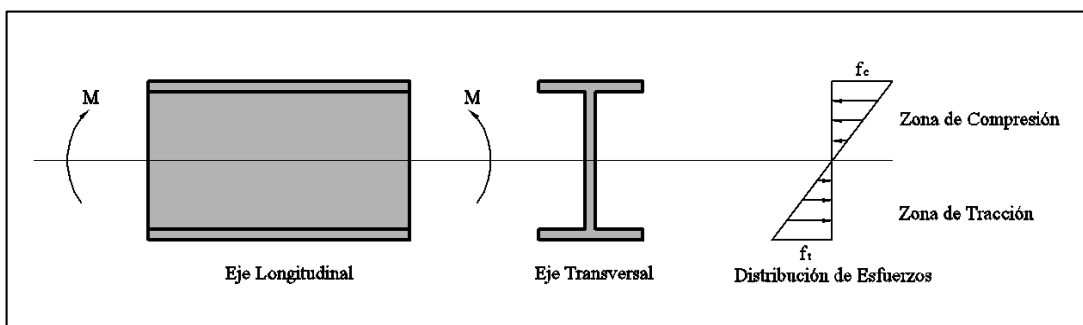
Zona Comprimida y Traccionada en la Viga.
